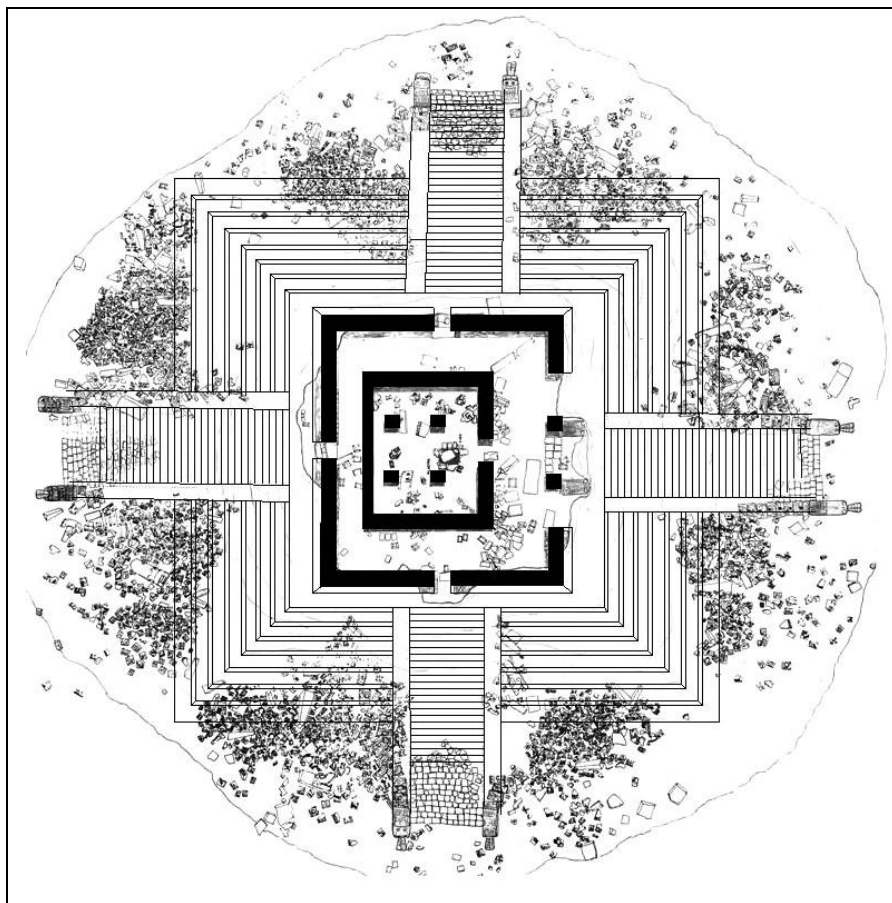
Planta de la Estructura 3C1 con piedras decoradas.
